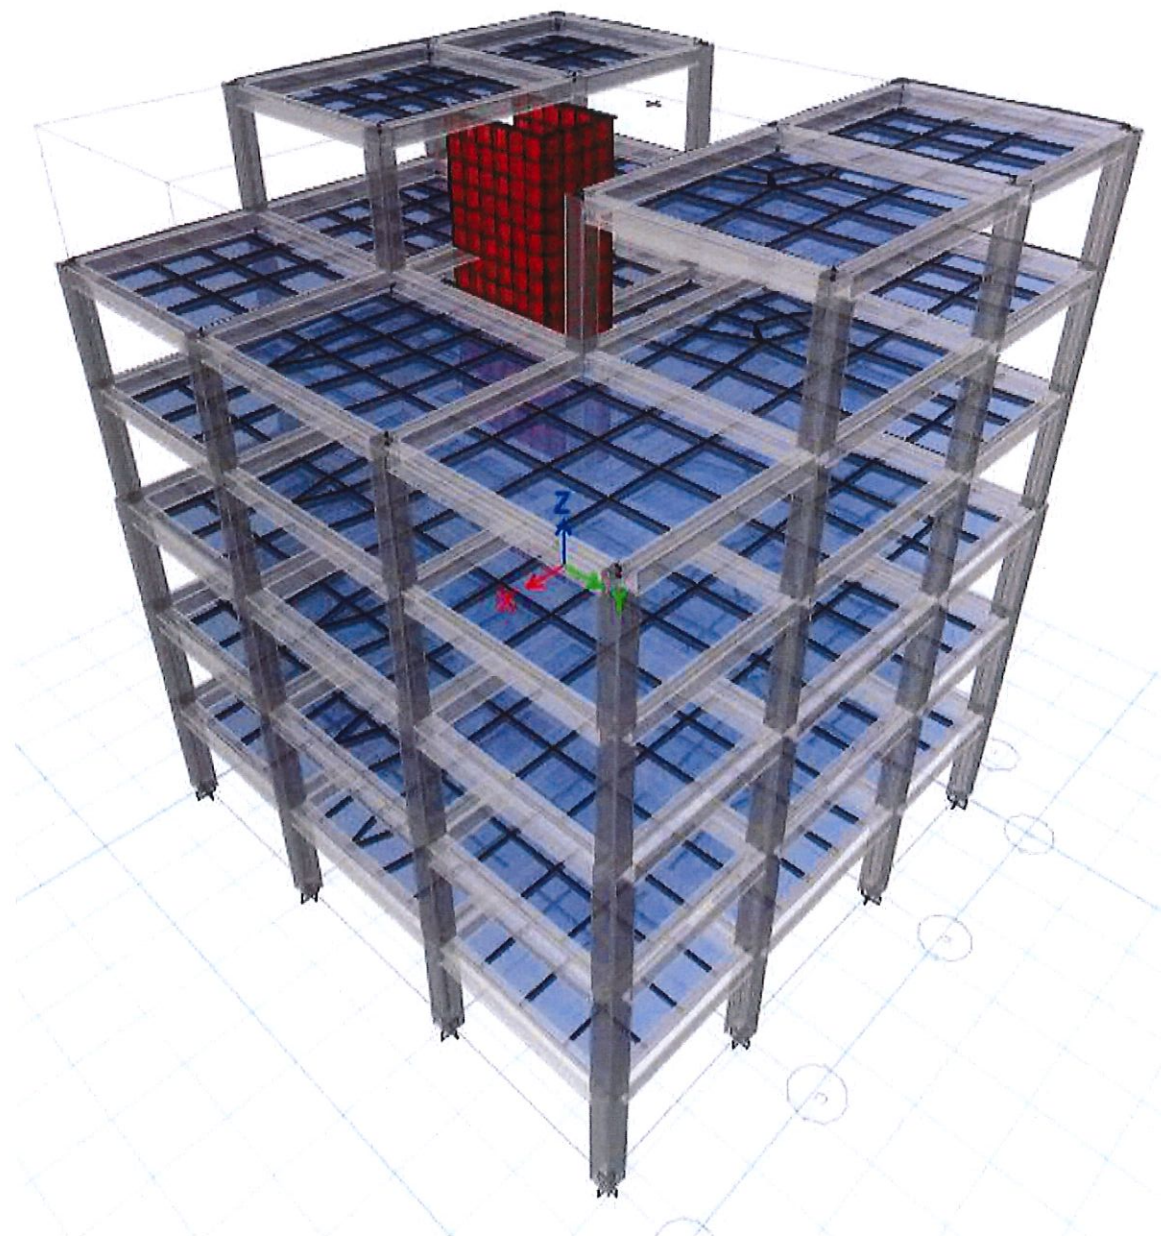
Sistema estructura a porticado de Hormigón Armado.
